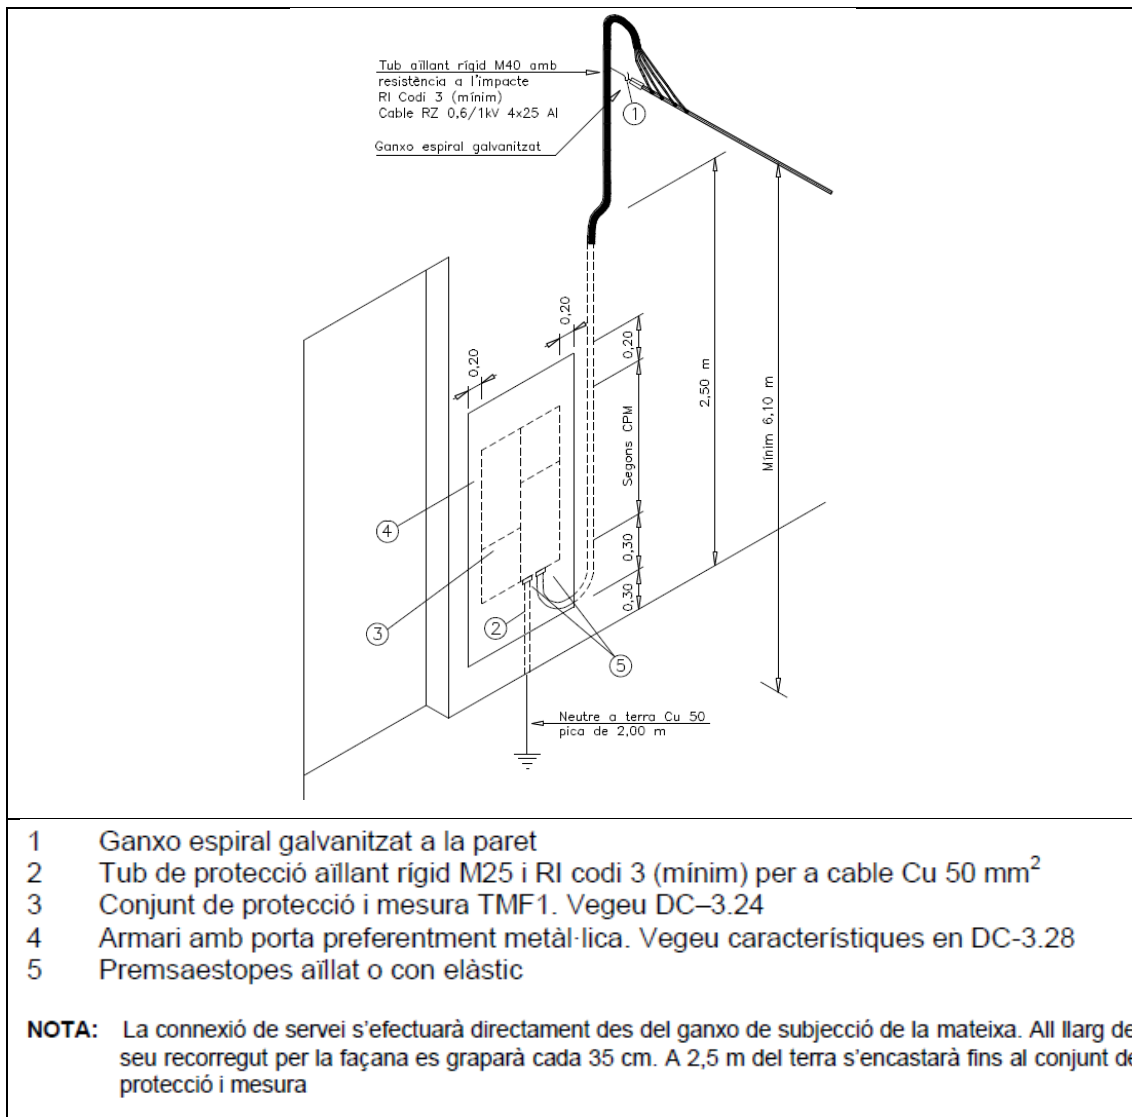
Emplaçament de conjunt de protecció i mesura a paret.
